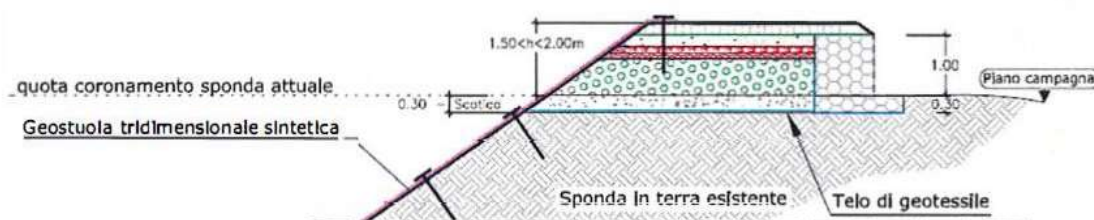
Intervento Tipo B3.2 – Adeguamento e sovrizzo dell'argine
